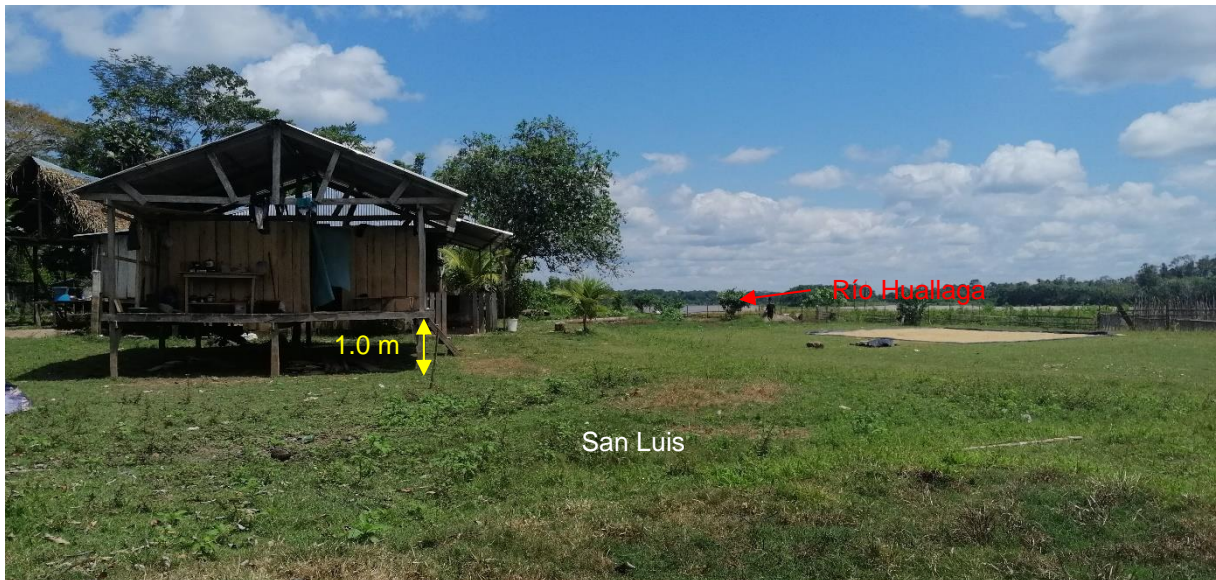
Vivienda con columnas de madera elevadas 1.0 m del terreno natural.
